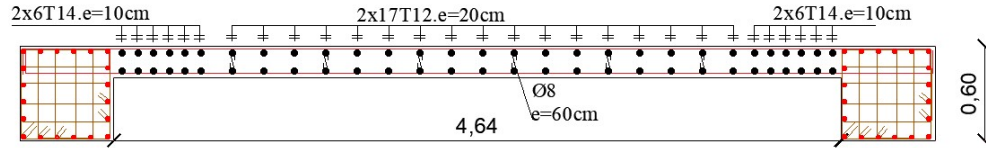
Exemple de ferrailage du voile RDC (L= 4.64 m)
